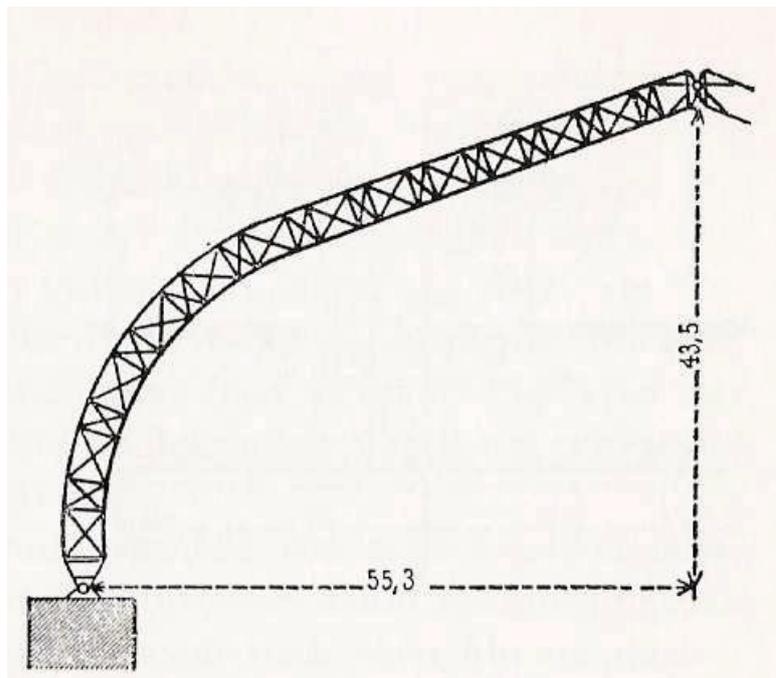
System der Binderkonstruktion der Maschinenhalle [1]
